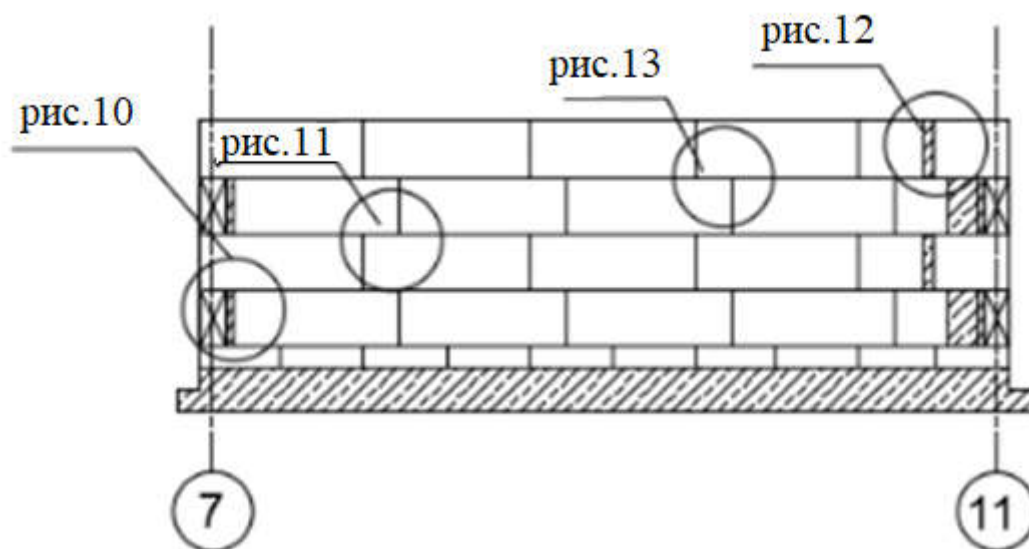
Схема нарушений фундаментов по оси Э в осях 7-11
